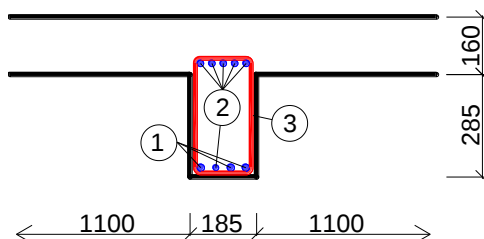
Detail sekané sondy u podpory u horního líce průvlaku
